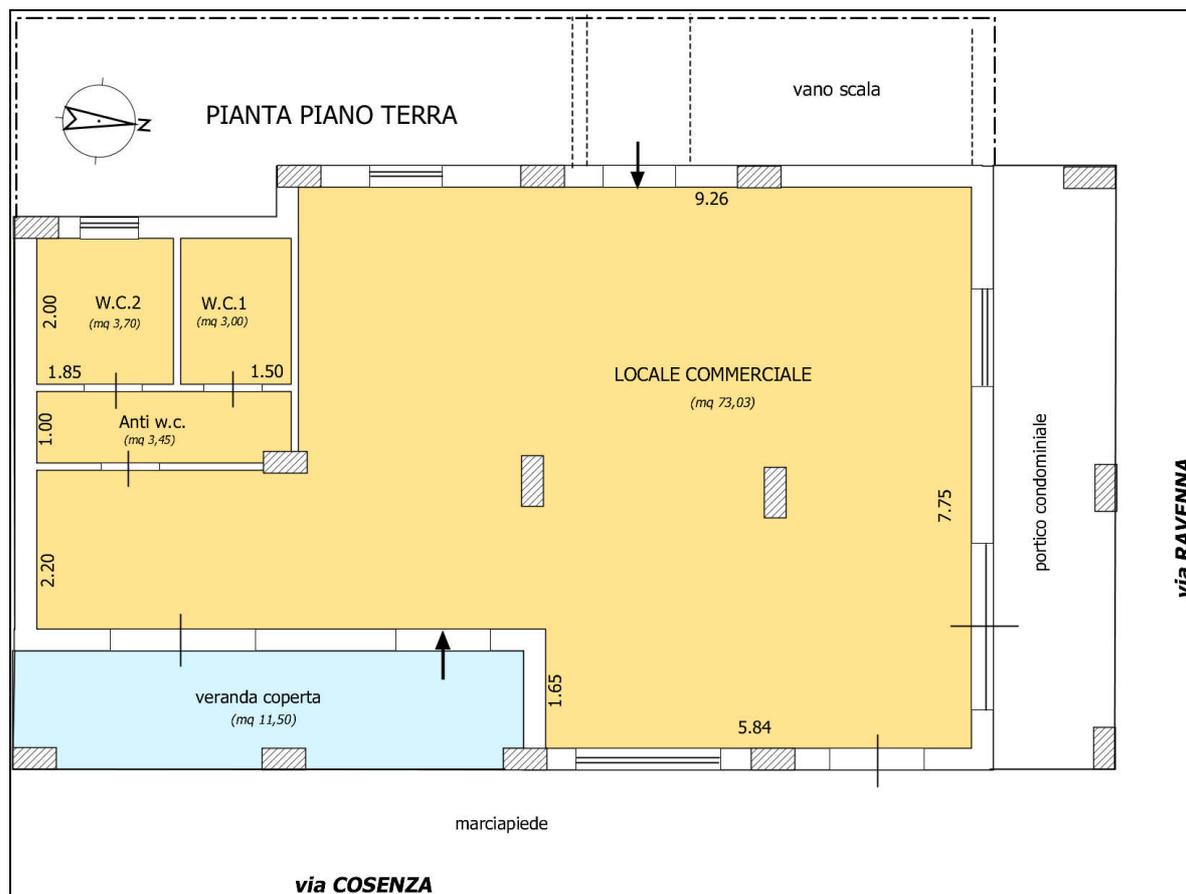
PIANTA PLANIMETRICA DEL LOCALE COMMERCIALE
